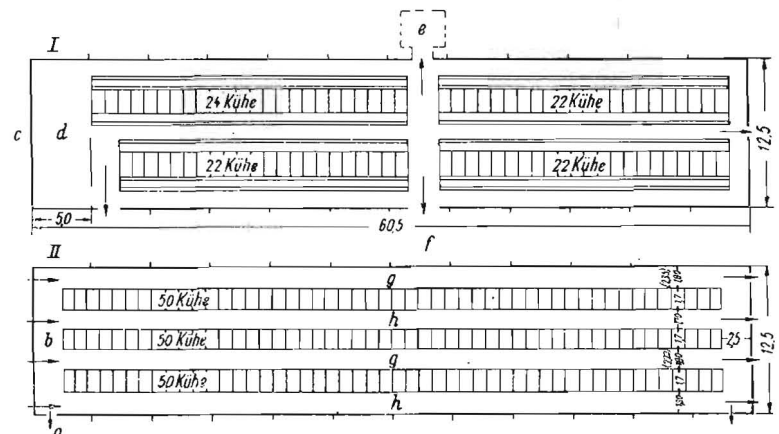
Zwei- und dreireihige Kuhställe in Skelettbauweise für Gebiete mit Weideaustrieb. I Grundriß: 2reihig, Mittellangstand. a Milchhaus mit Melkständen, b Futterterrasse, unabhängig vom Stallgebäude, c Milchräume, d Futterterrasse, e Milchhaus (angebautes Milchhaus oder am Giebel eingebaute Milchräume), f angebautes Milchhaus mit Melkständen, g Durchfahrtsfuttergang, h Durchfahrtdunggang. II Grundriß: 3reihig, Kurzstand
